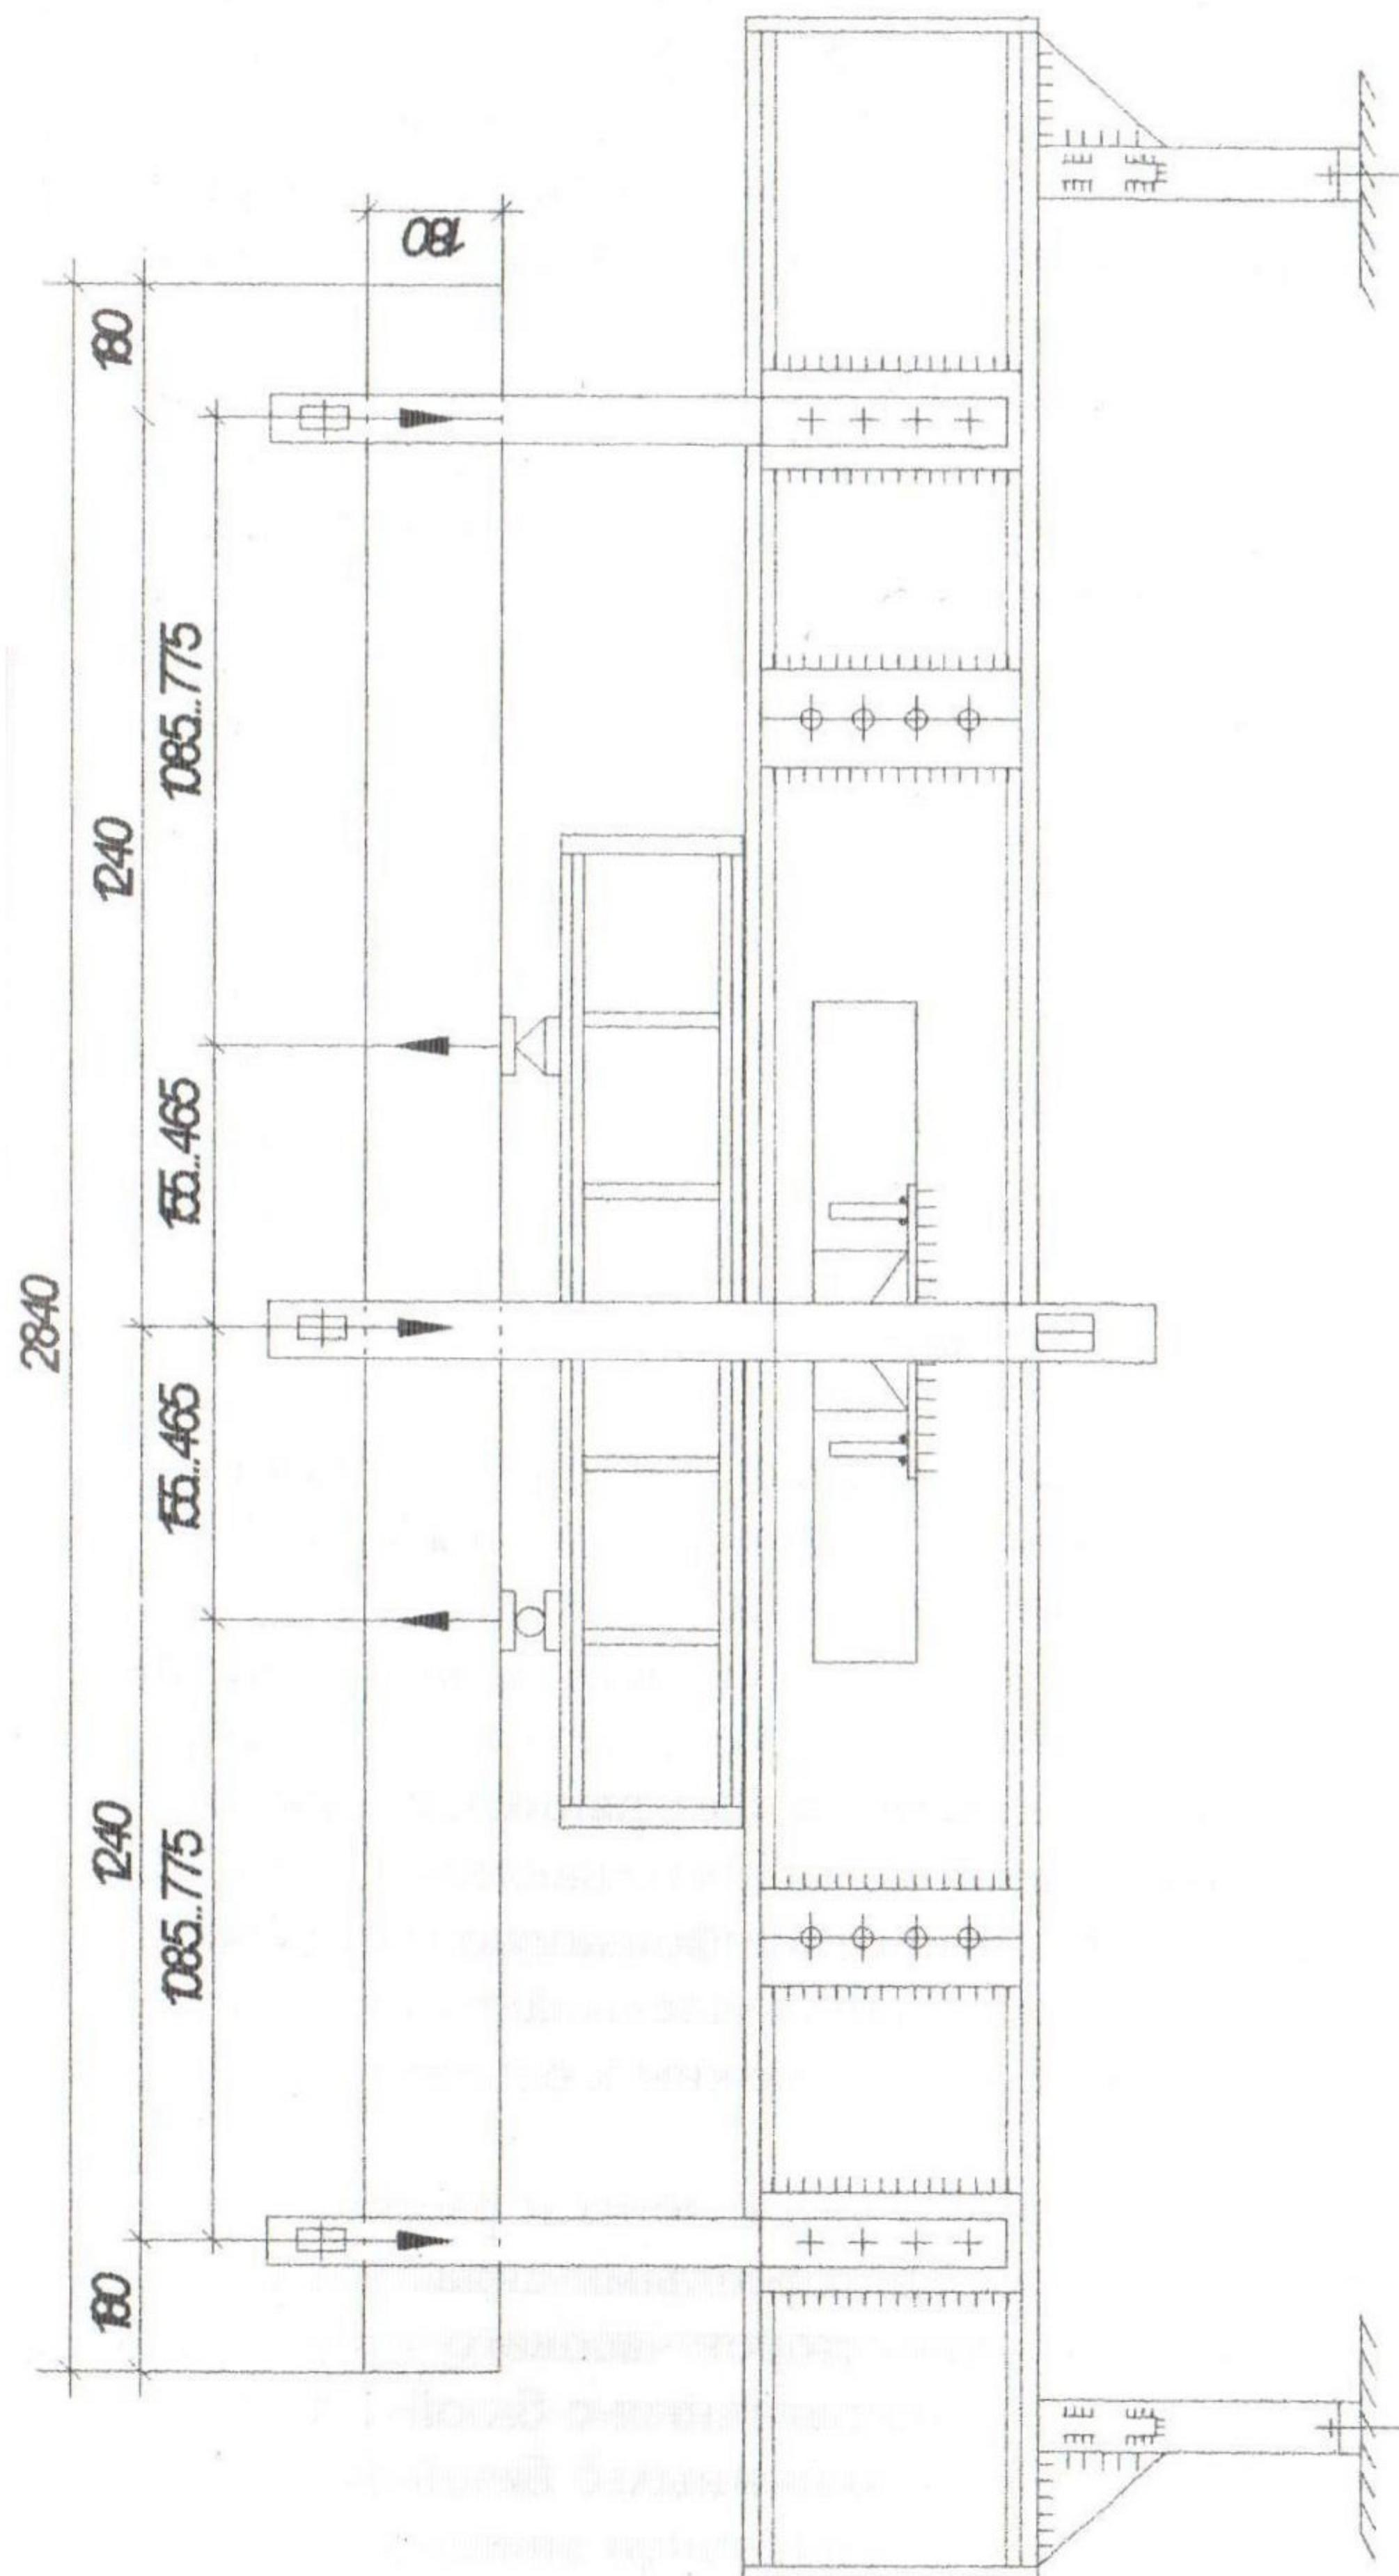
Силовая установка для испытания на поперечный изгиб двухпролетной опытной балки
